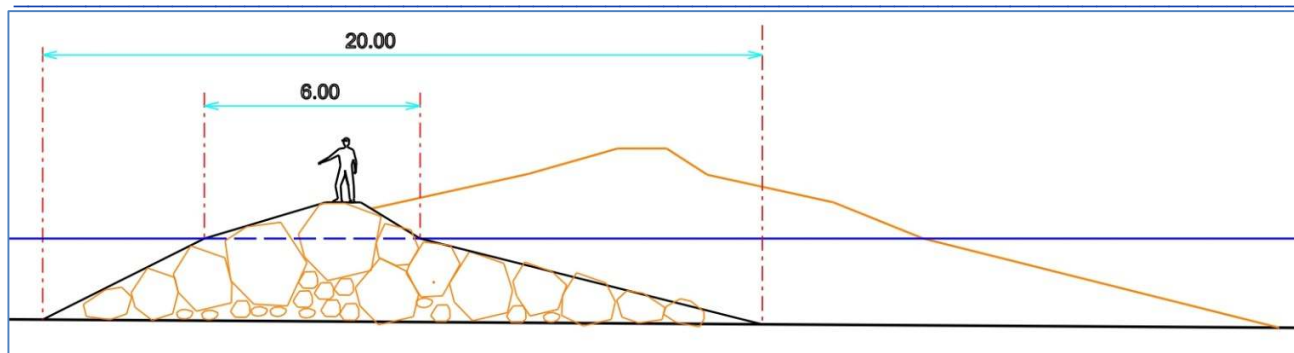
Opere in progetto e accrescimento della spiaggia (layout finale ottimizzato)
